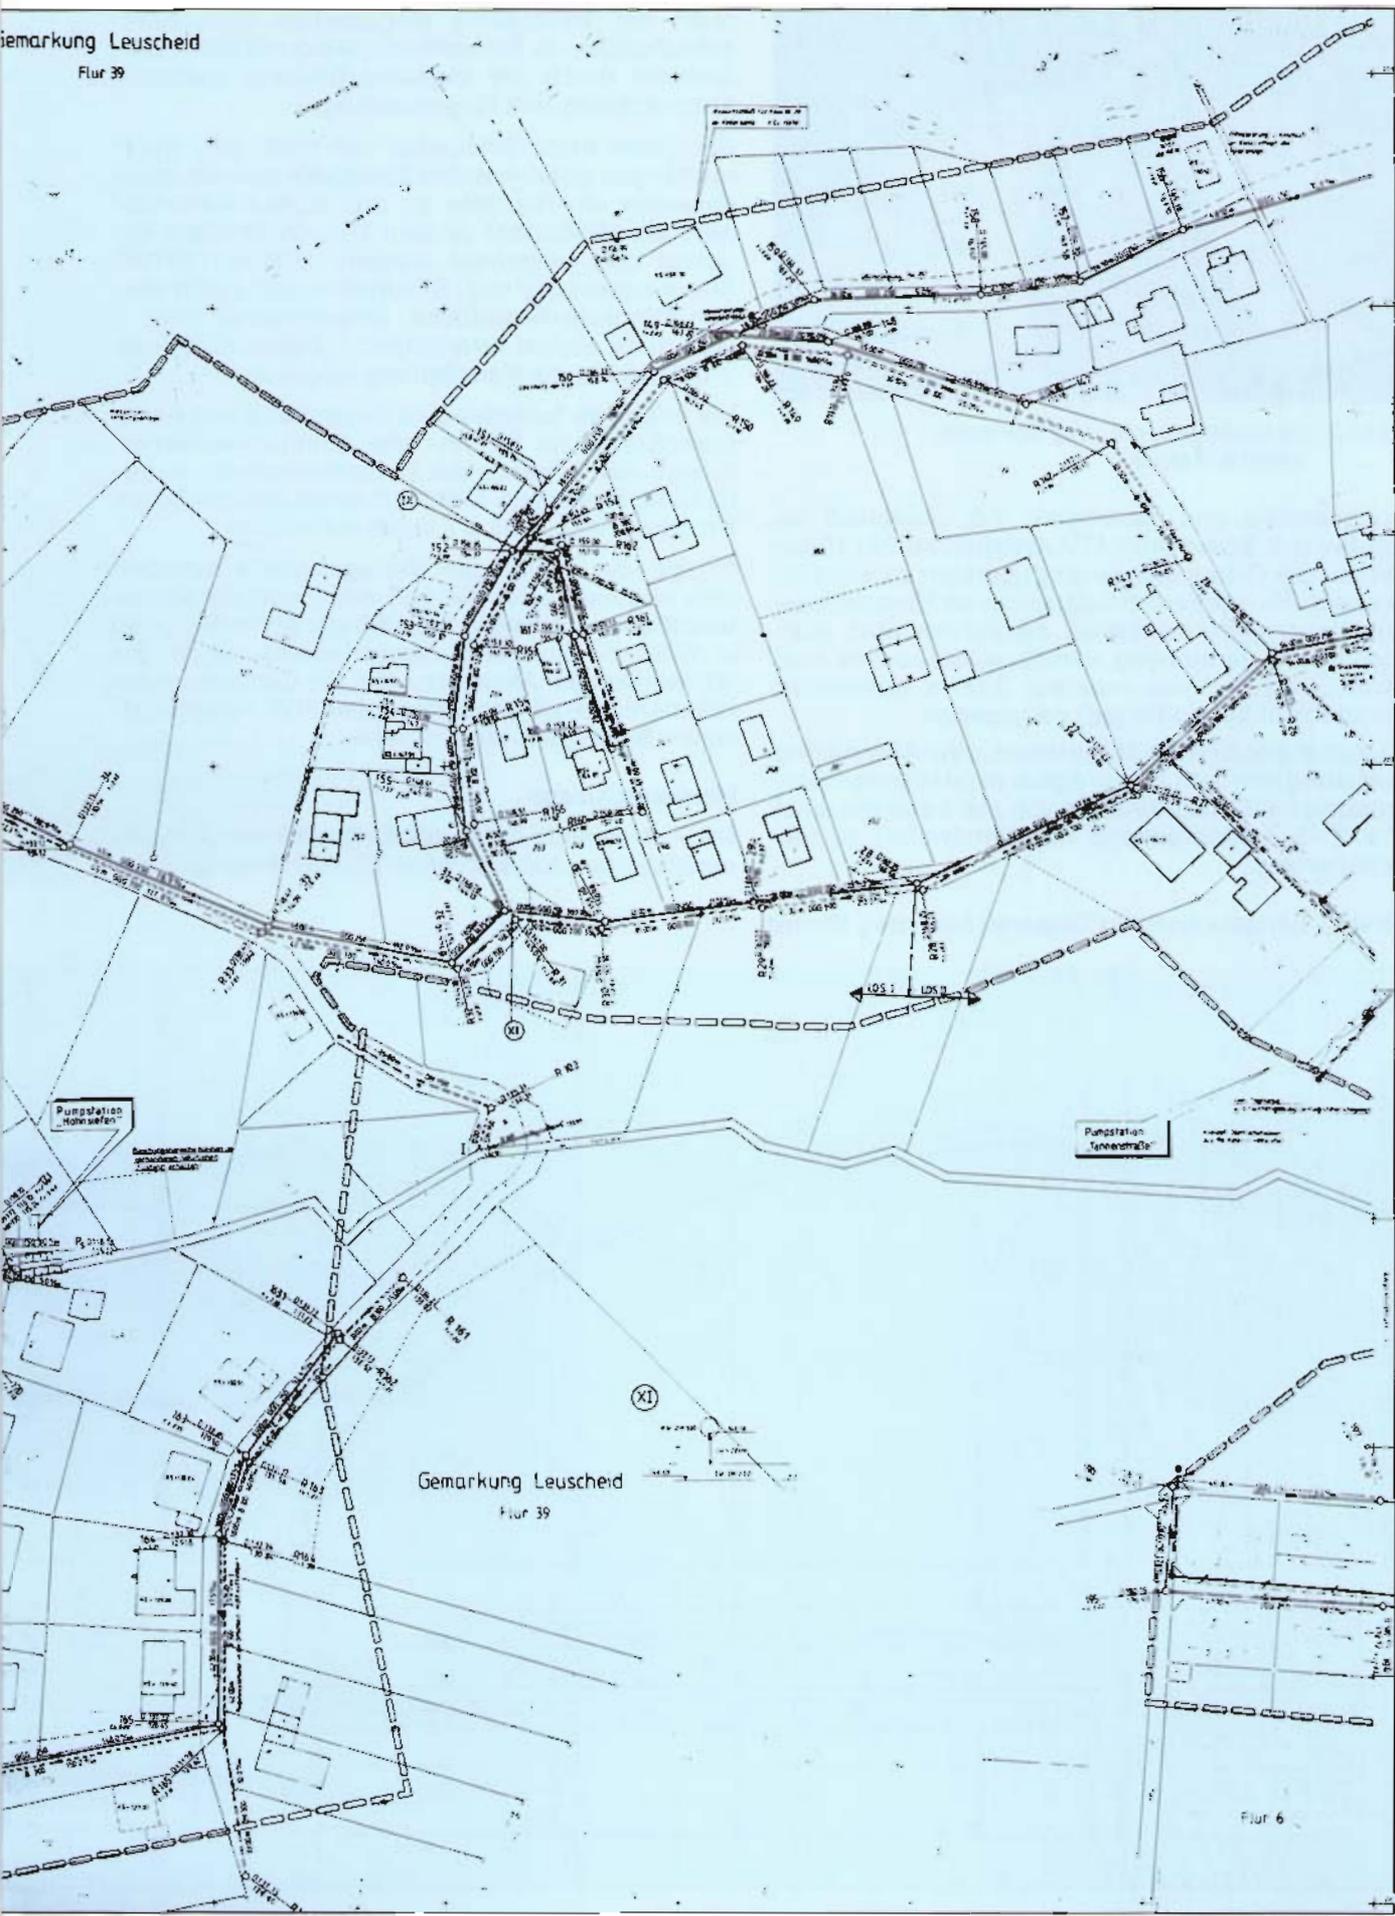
Ausführungsplanung der Ortsentwässerung Werfen – Lageplan
